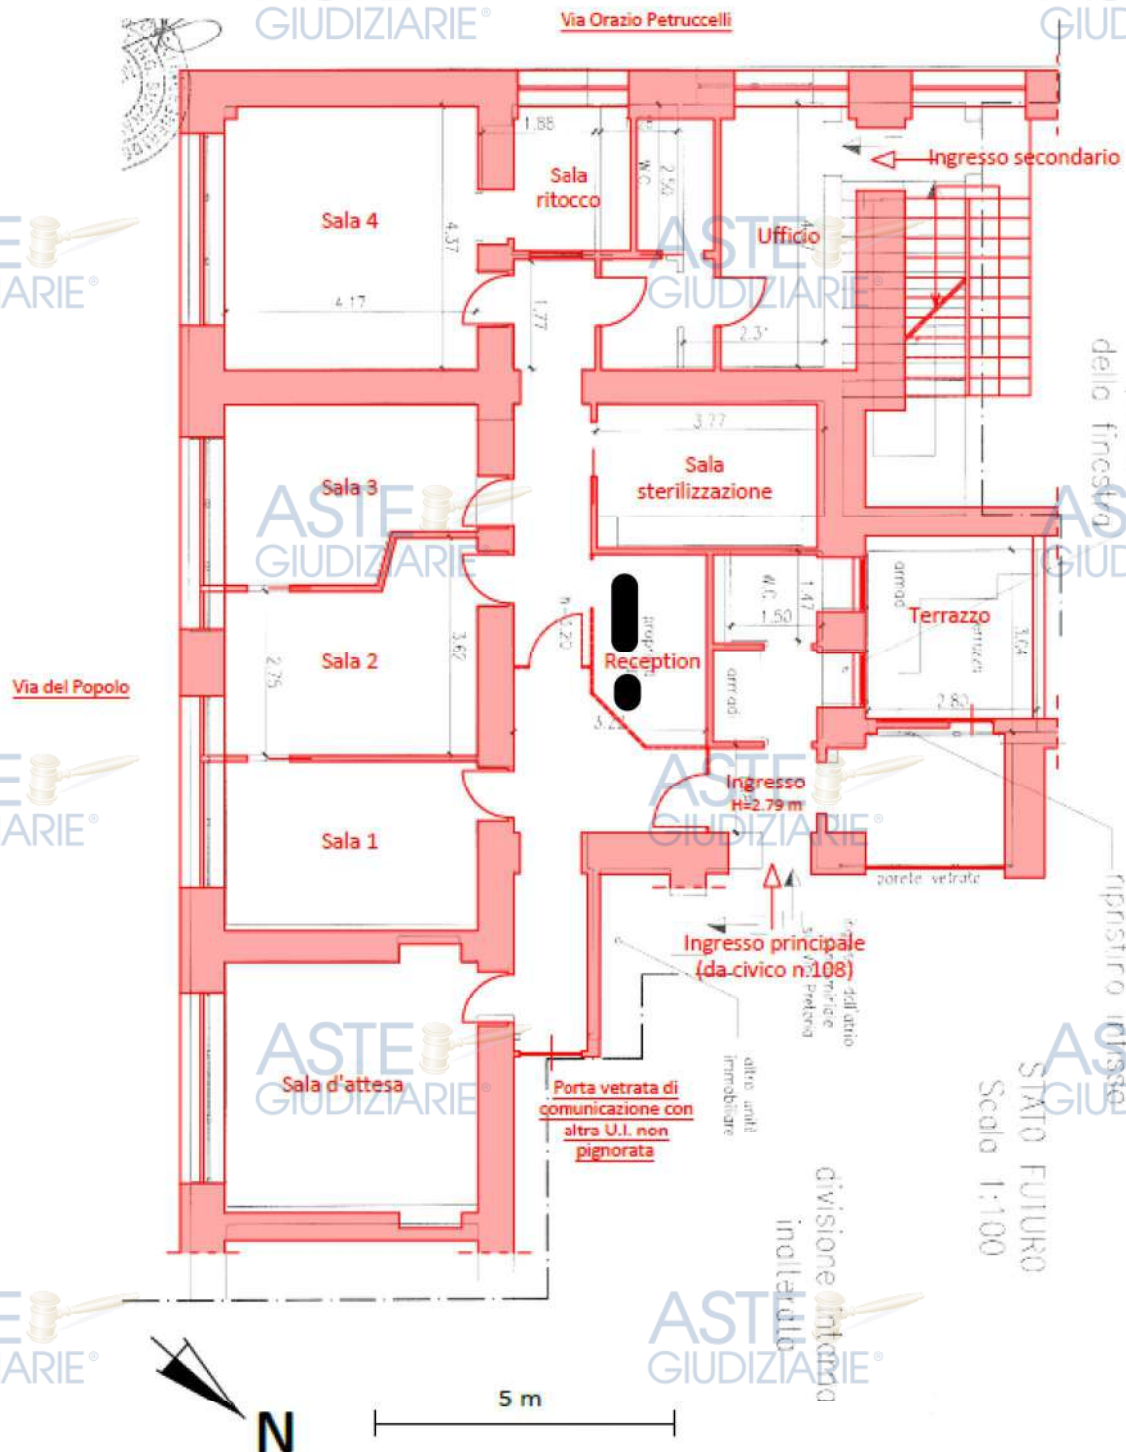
Sovrapposizione stato reale dei luoghi e progetto autorizzato - Planimetria studio privato piano terra
